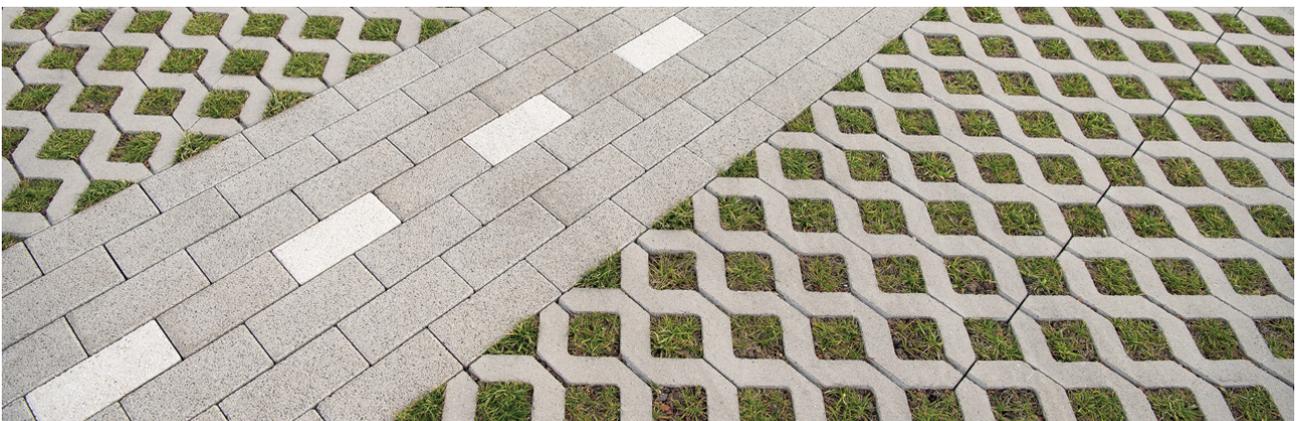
Dalles-gazon en béton (Parking Brico Plan-it – Ternat) (Stradus, s.d.)
